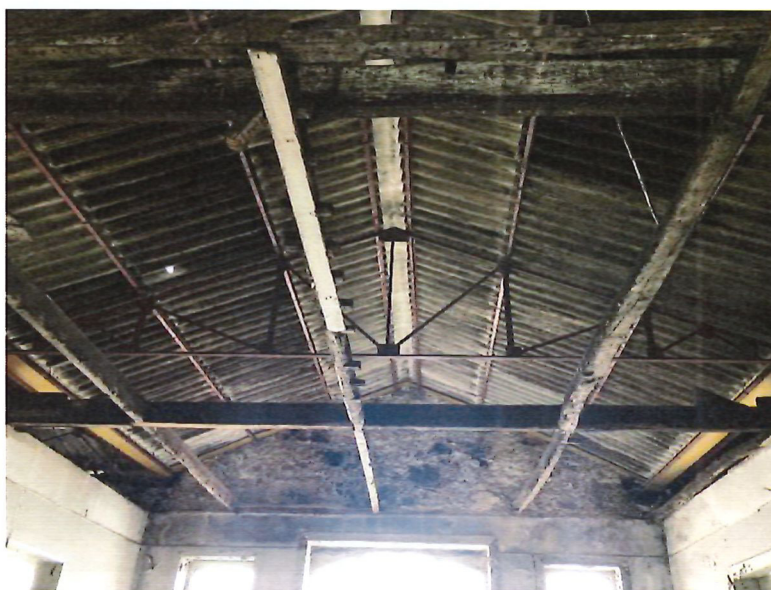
| Pormenor – Estrutura metálica / Suporte cobertura
